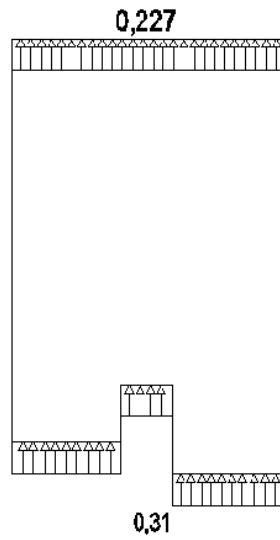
Pressão Vento Sul - Norte nas fachadas
